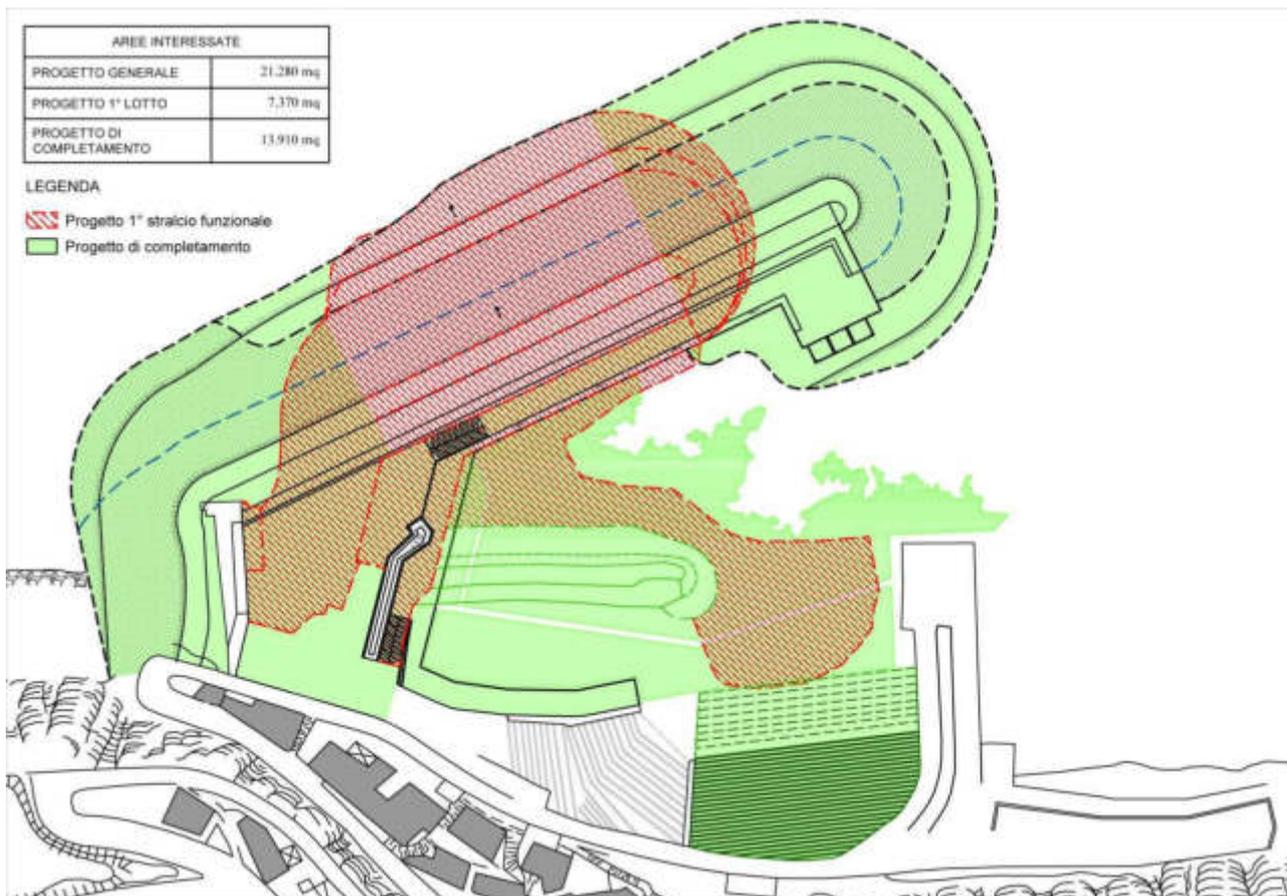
Planimetria con indicazione delle dimensioni del progetto
